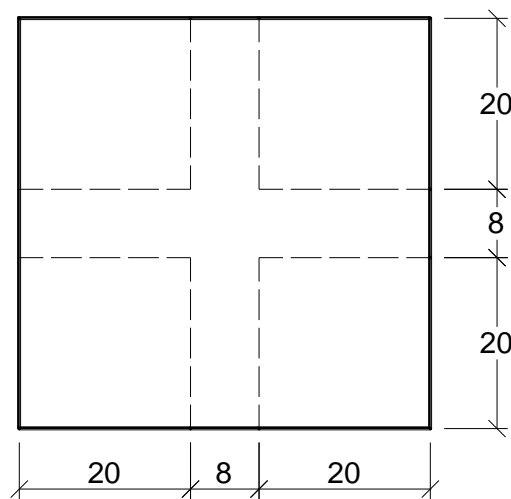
Área da laje considerada no cálculo do peso próprio.
